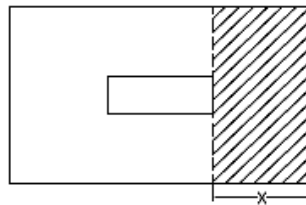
Sección considerada para el cálculo del refuerzo por flexión.
